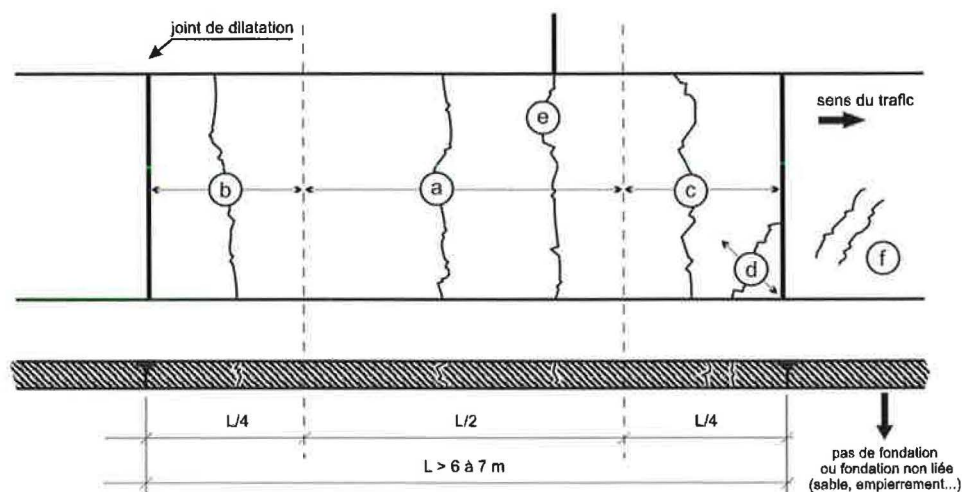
Types de fissures susceptibles d'apparaître dans des routes en béton de conception ancienne
